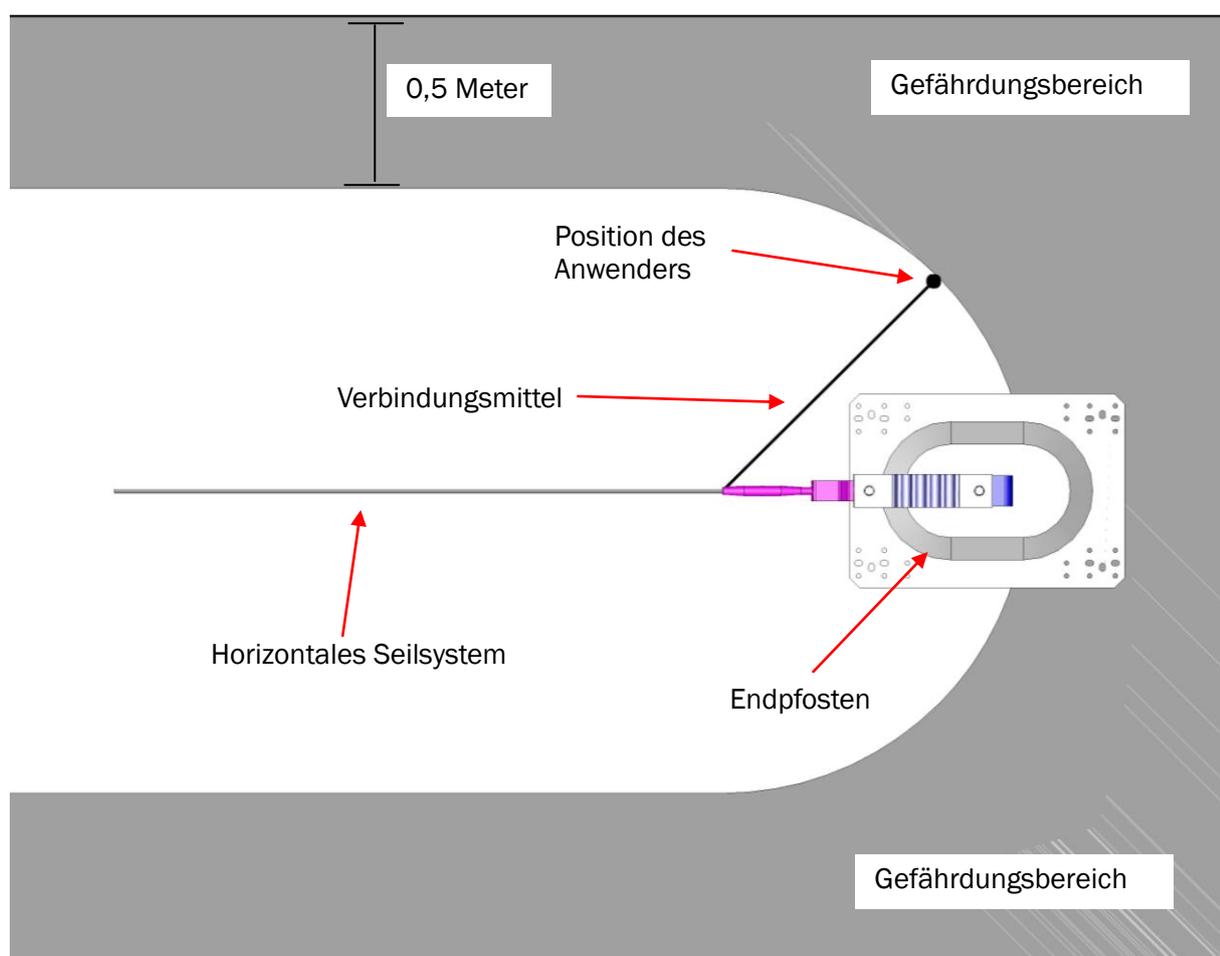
Umfang Dachzugang – Rückhaltesysteme
